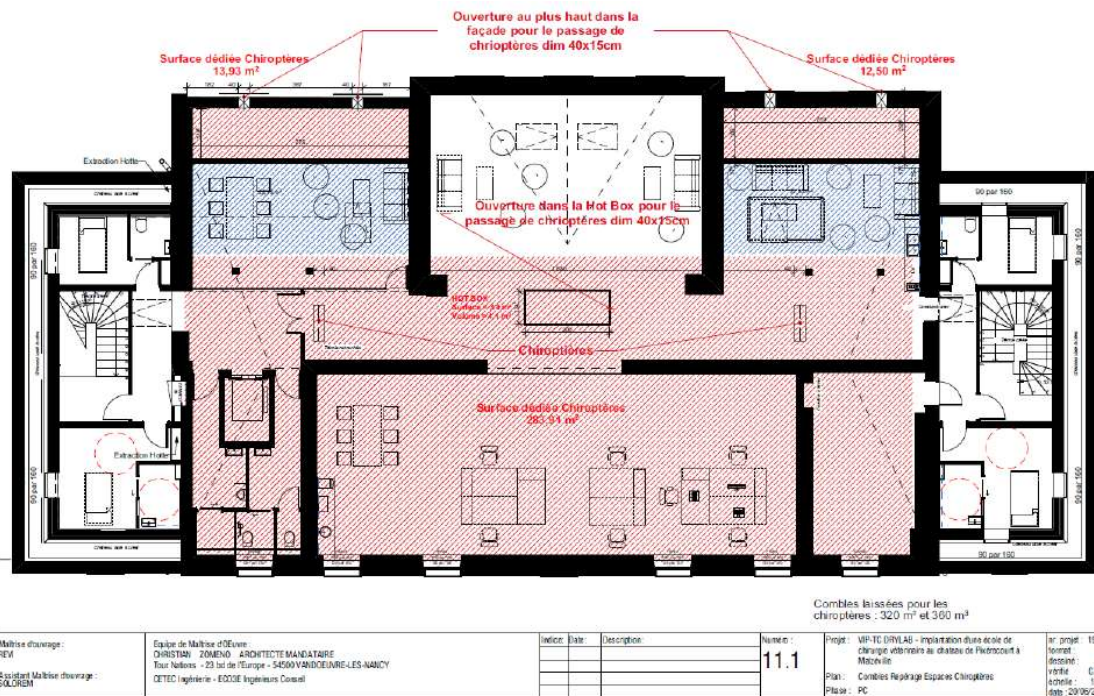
Coupe du château de Pixérécourt (Atelier Zoméno, 2025)
